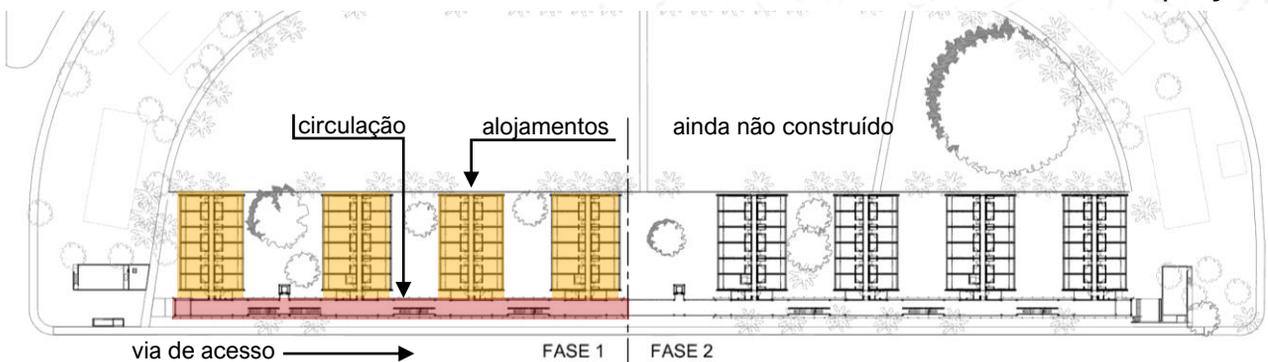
Planta de implantação - Alojamento estudantil Ciudad del Saber. Fonte: Archdaily, 2014.
